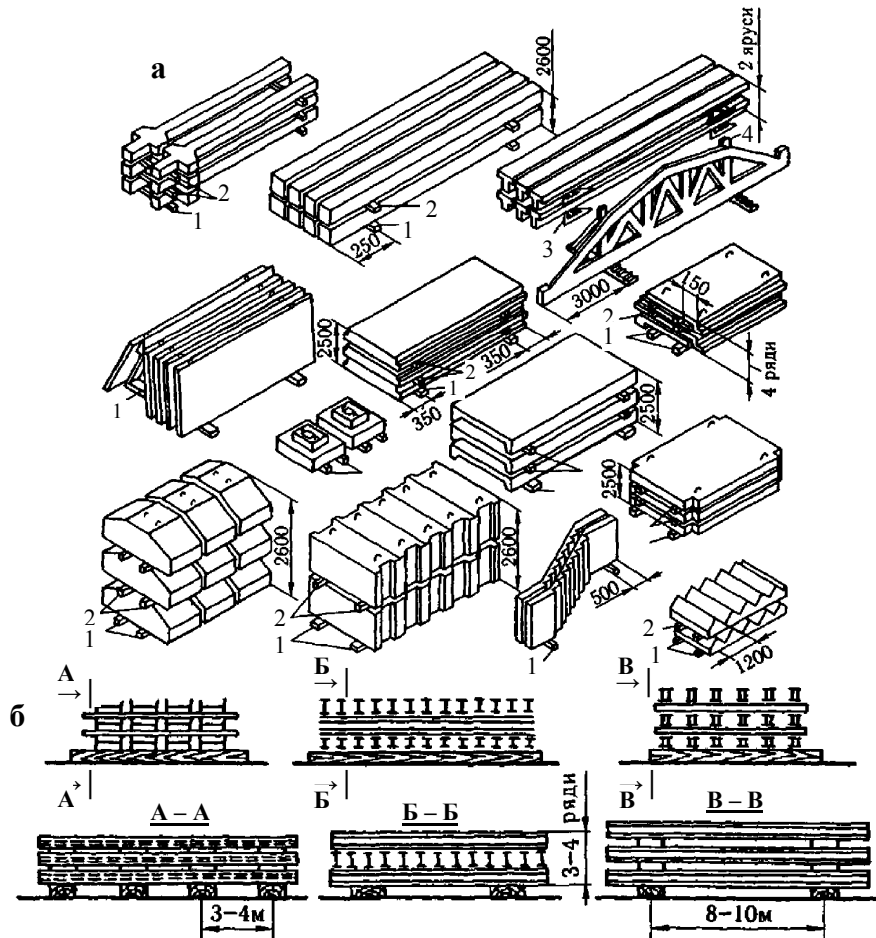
Складування будівельних конструкцій: а – залізобетонних; б – металевих; 1 – лежні-підкладки; 2 – прокладки; 3 – металеві опори; 4 – касета
